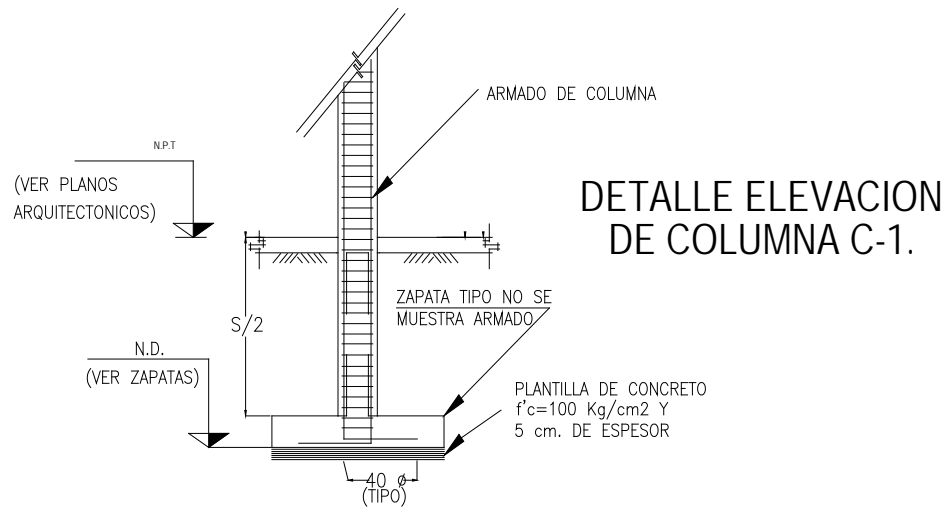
Vista en corte del anclaje de acero de las columnas en las zapatas de cimentación.
